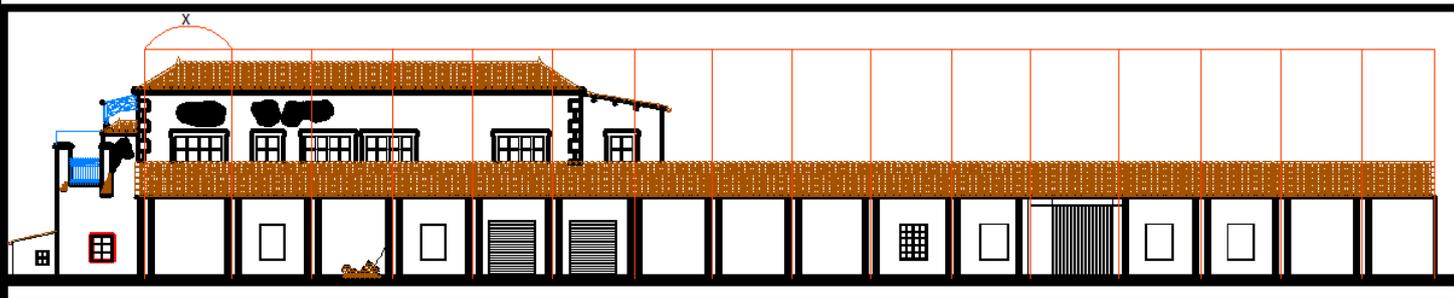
Plan de composition de la façade sud (Ateliers et clinique)
